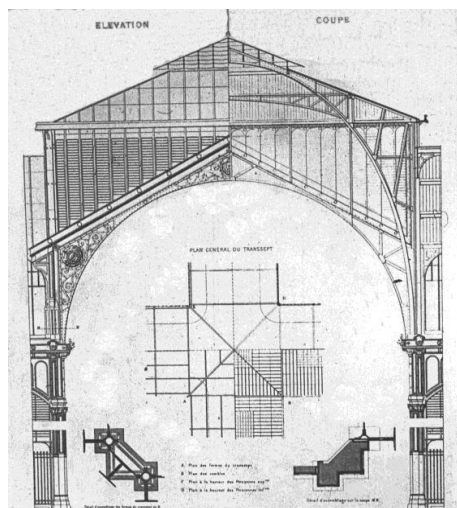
"Sección constructiva. *Les Halles Centrales de Paris*". Victor Baltard. 1852-1862
